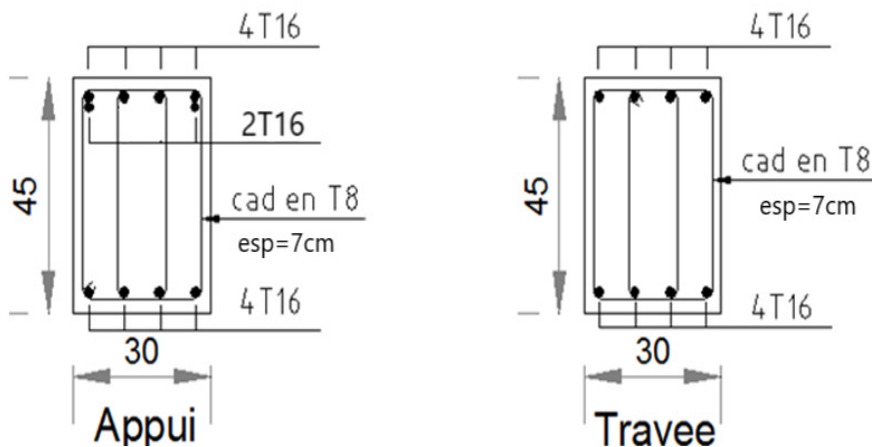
Ferrailage des poutres secondaire en travée et sur appui
